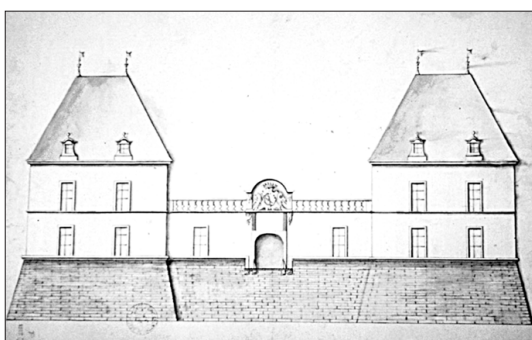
et 107 – Plans de restauration du XVIII^e s. (E 2161) : Façade occidentale et plan
